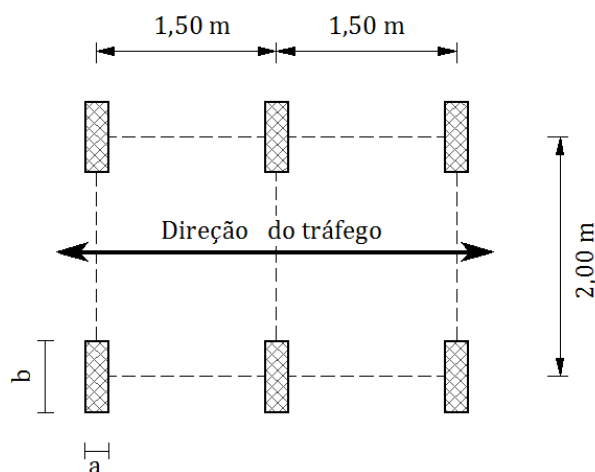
Configuração em planta do veículo tipo do RSA
